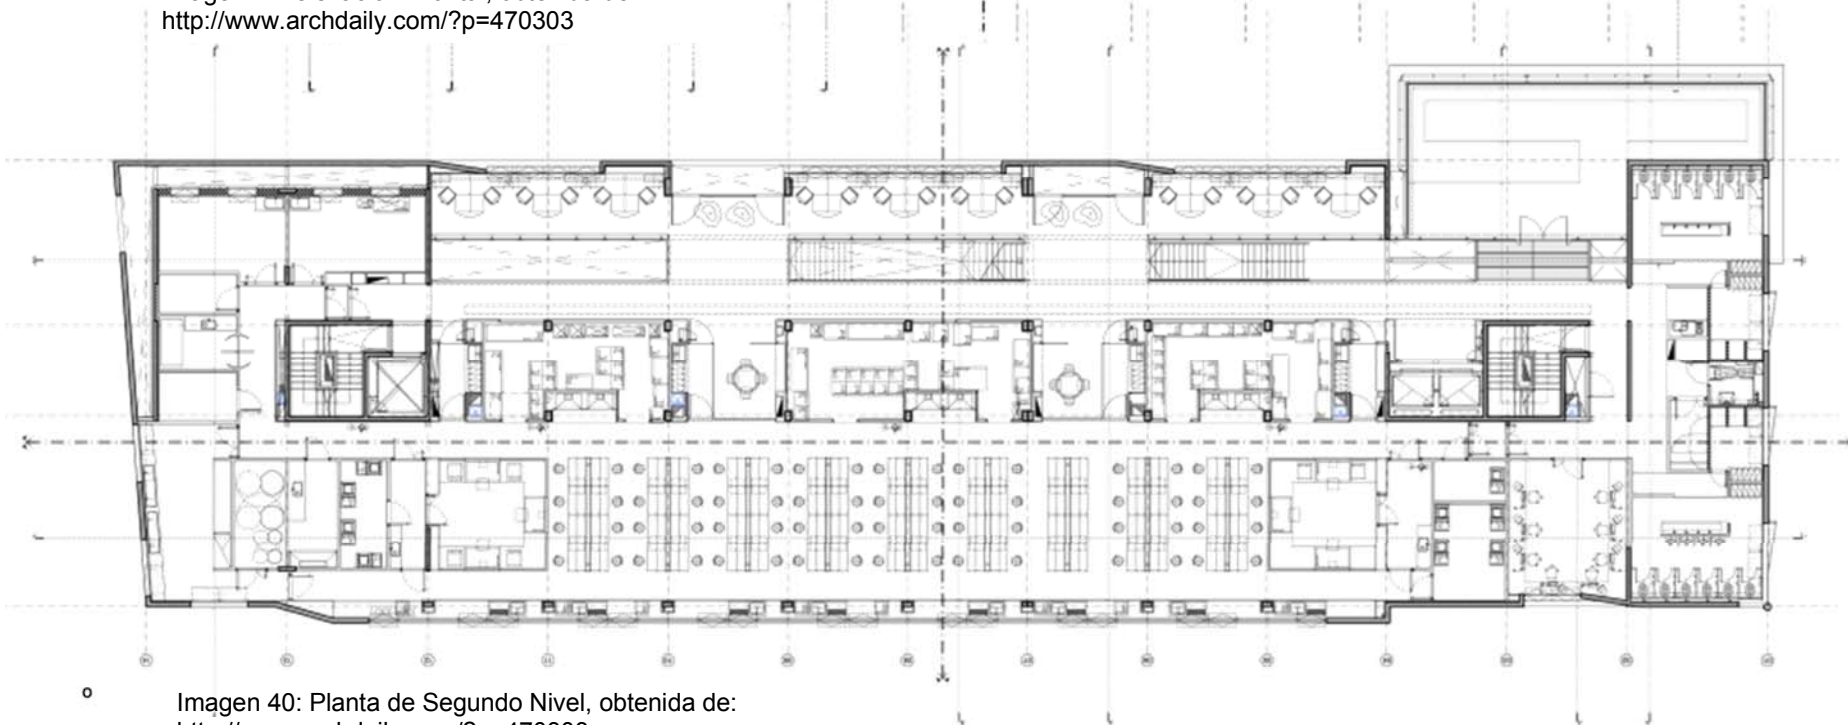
Planta de Segundo Nivel, obtenida de: <http://www.archdaily.com/?p=470303>
